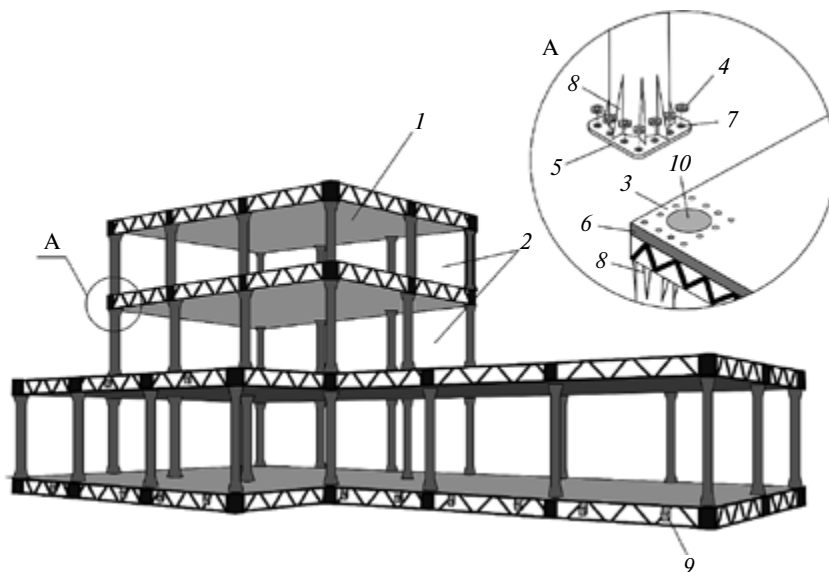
Вариант установки первых трех этажей здания из предлагаемых строительных модулей: 1 – строительный потолок; 2 – последующие строительные модули; 3 – болтовые отверстия; 4 – высокопрочные болты; 5 – планки; 6 – верхний бетонный пояс; 7 – болтовые отверстия; 8 – ребра жесткости; 9 – крепления; 10 – бетон
